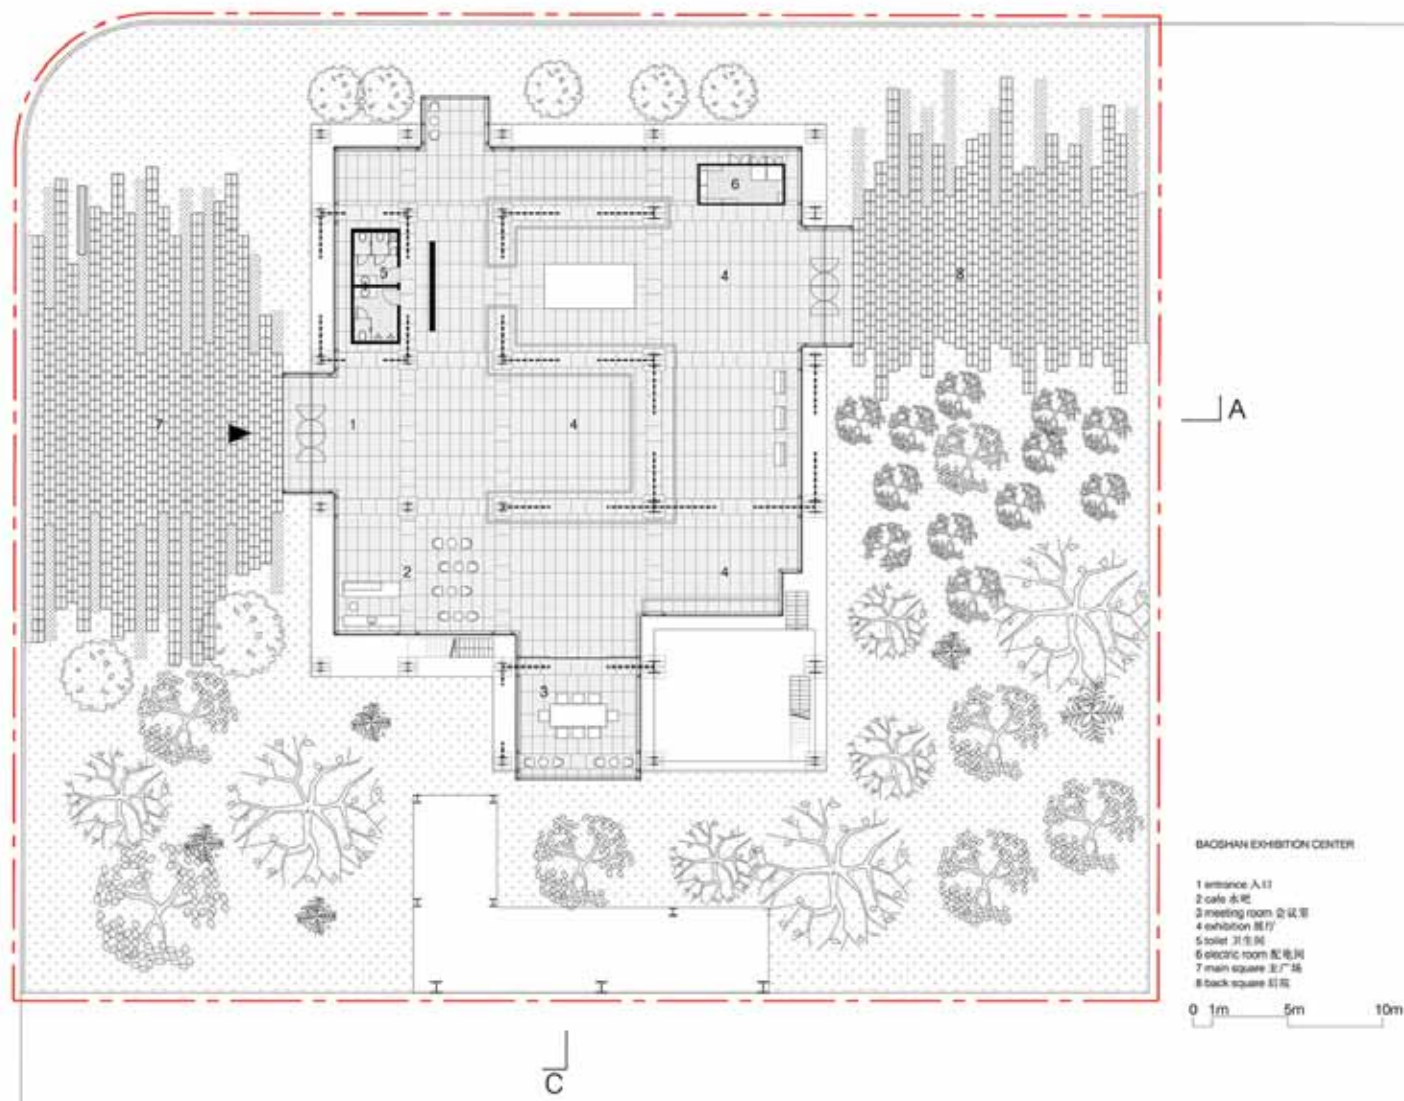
| Planimetria di progetto (© Kokaistudios)
